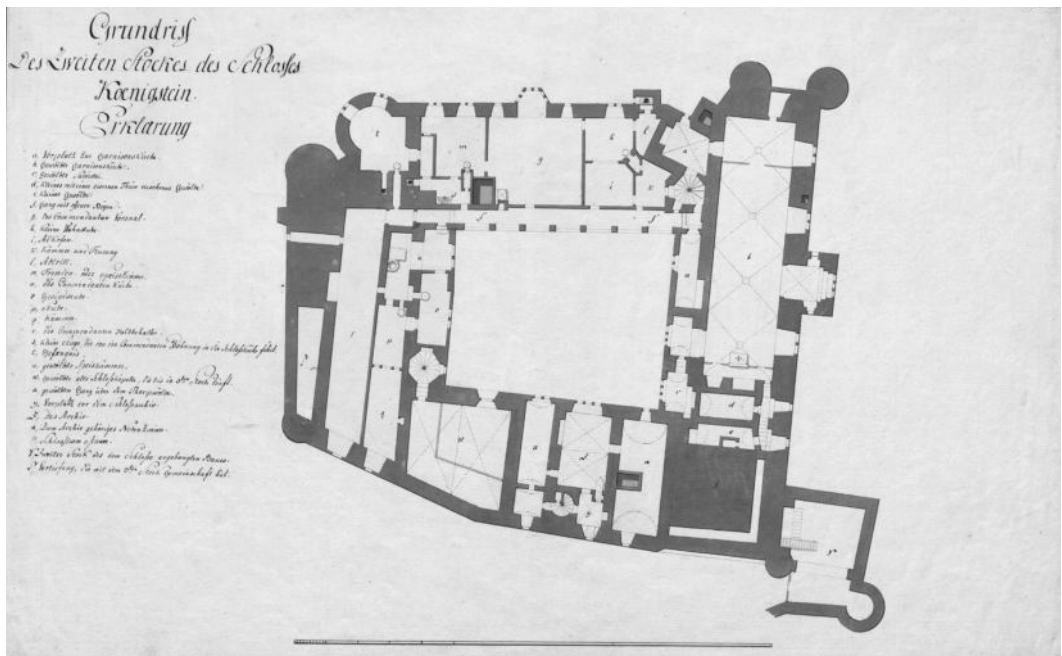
„Grundriss Des Zweiten Stockes des Schlosses Koenigstein“, Ingenieur-Oberleutnant Jean François Xavier Mangin, im Jahr 1790/1791.
